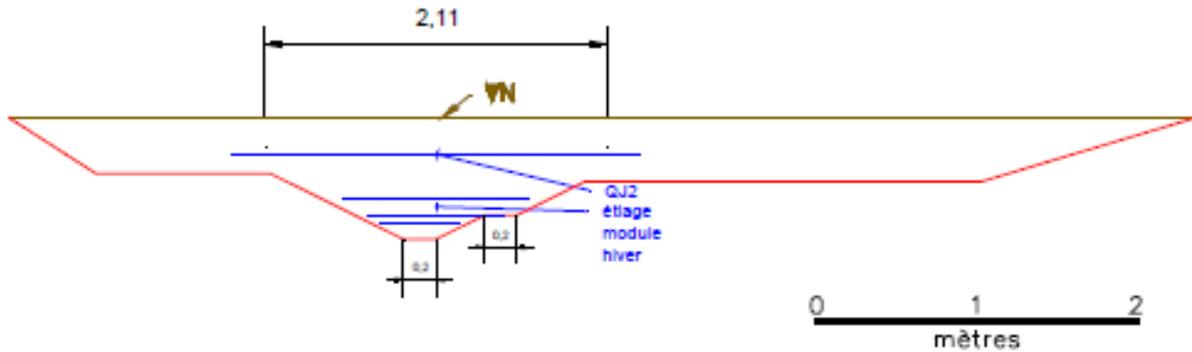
Profil de coupe type de terrassement (source : Cariçaie)
